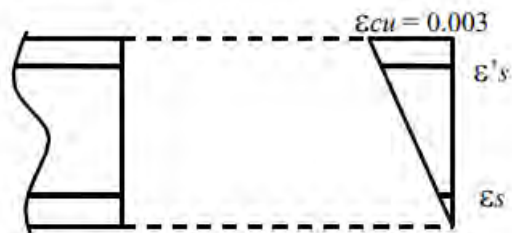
Esquema de sección de concreto reforzada parcialmente fisurada.
